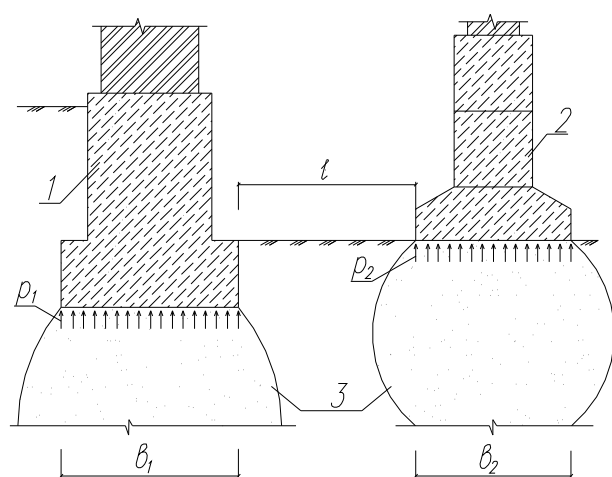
Примыкание фундаментов к существующему зданию при различной глубине заложения подошвы
